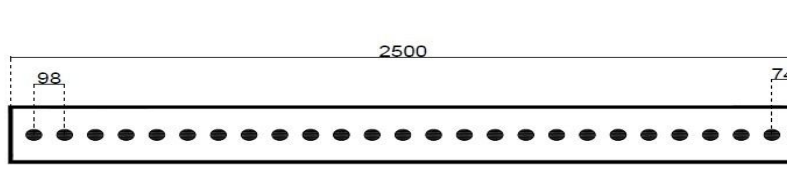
Nombre de connecteurs par demi-portée & Espacement dans la poutre secondaire
